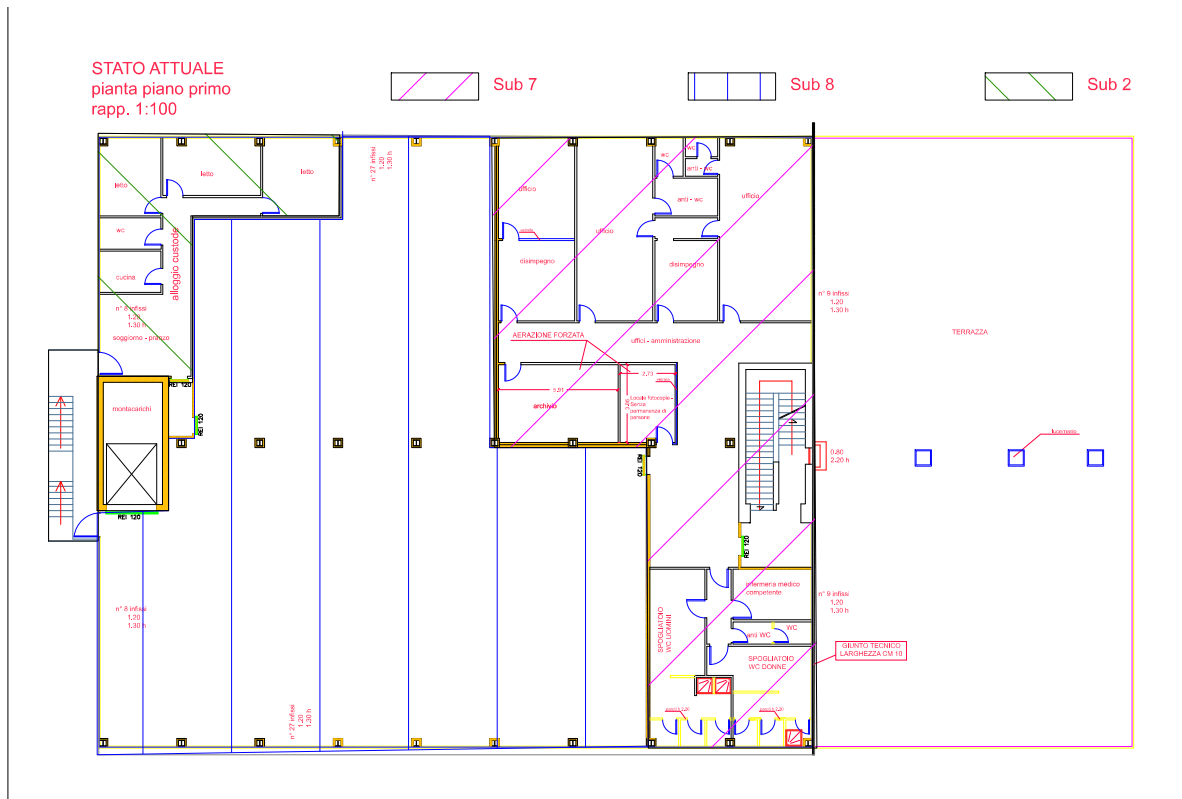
Planimetria rilevata Piano primo con individuazione sub 7, sub 8 e sub 2
